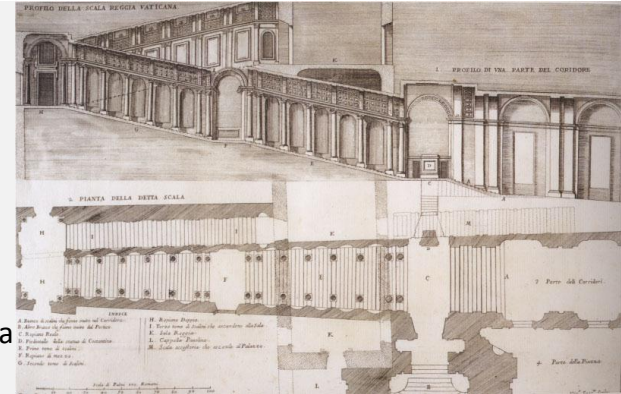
perfil e planta da Scala Reggia Vaticana, Roma.
